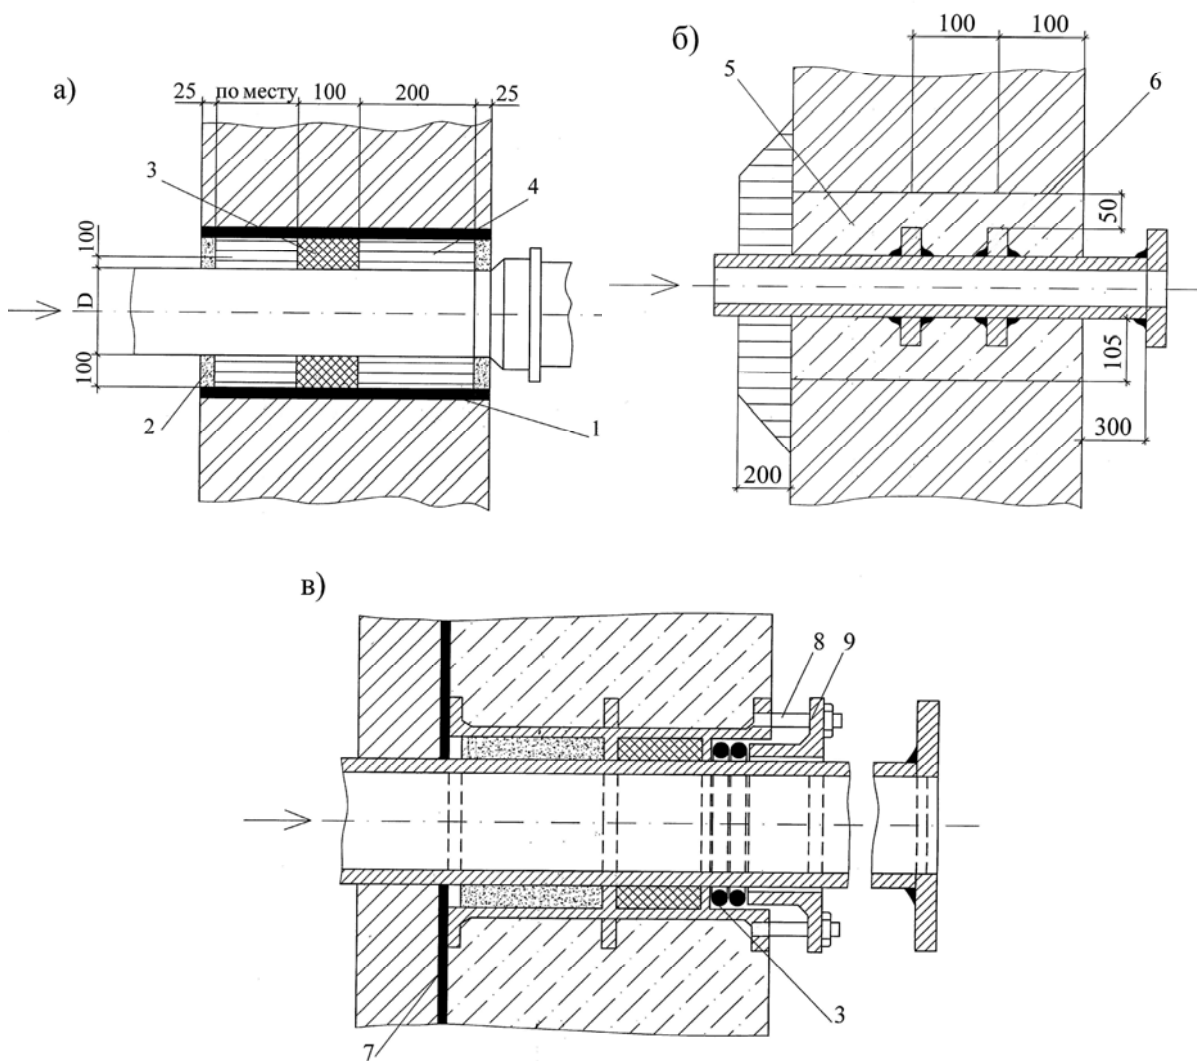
Заделка трубы ввода в фундаменте здания в сухих (а),
